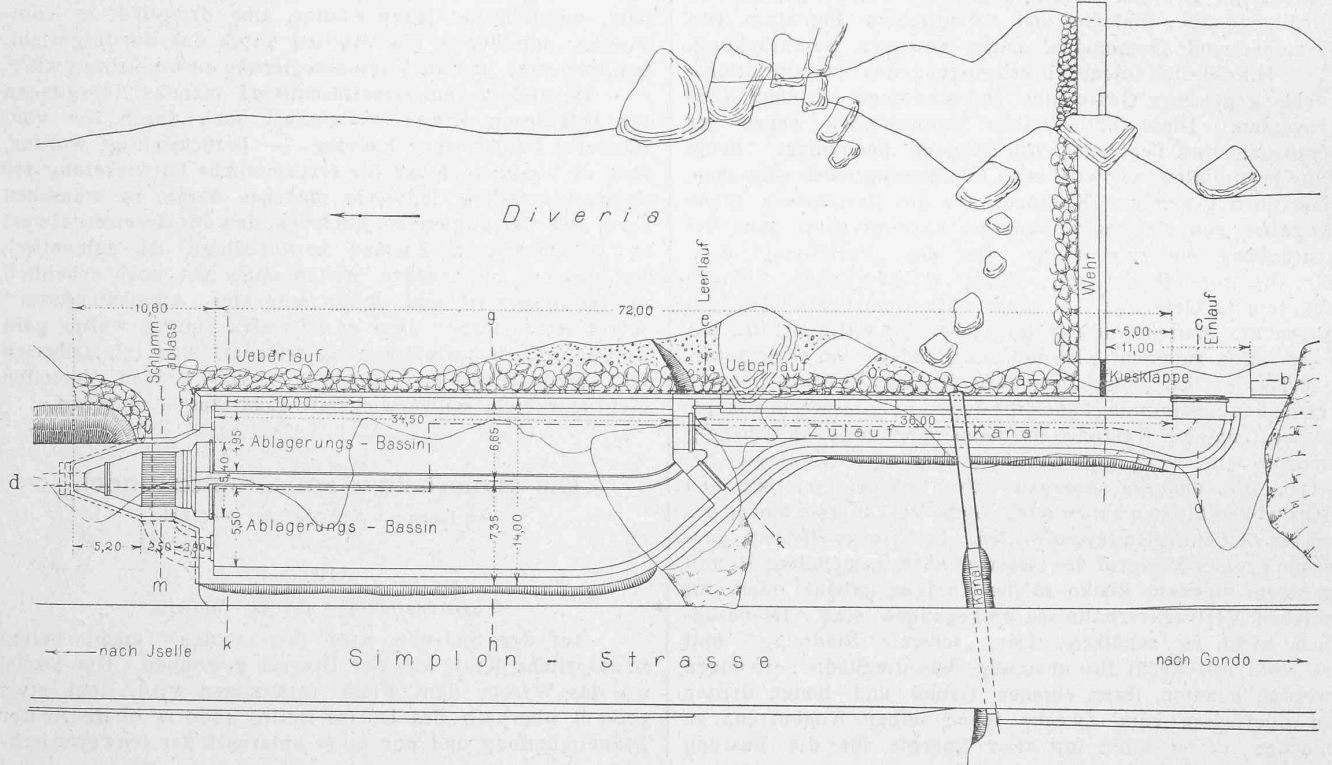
Die Wasserkraftanlage. — Lageplan der Wasserfassung an der Diveria. — Masstab 1:500.
